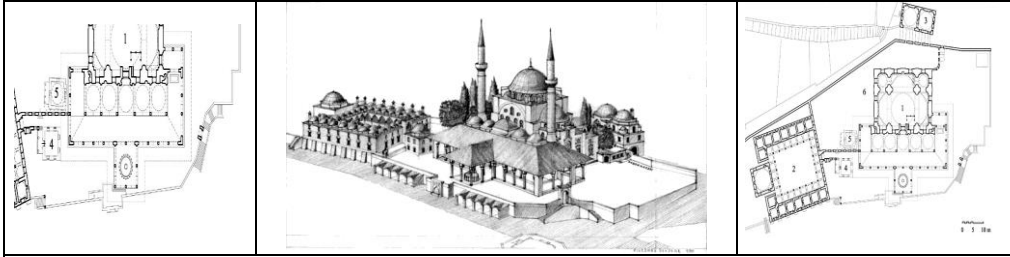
مسقط أفقي ليشيل امارت (دار المرق الخضراء) ليخشي بك في تيرة والسقيفة التي تتقدمها. (عن: أصلان آبا بتصرف).
